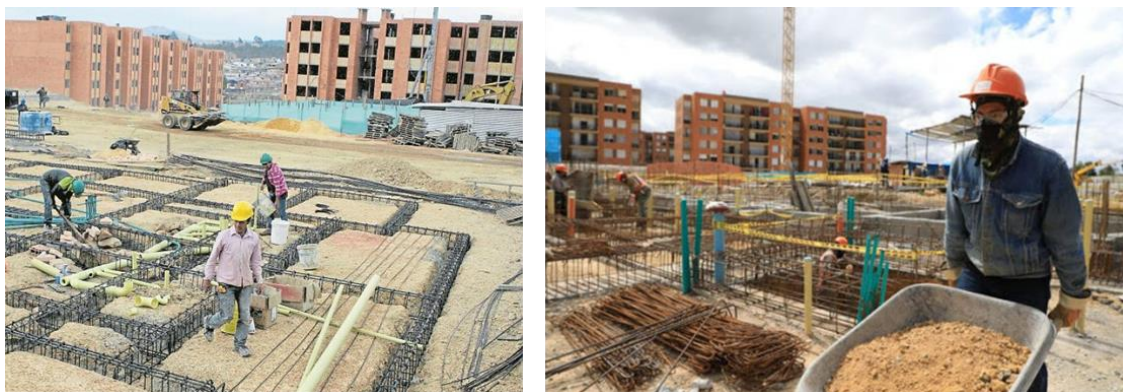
Construcción de losa de cimentación en viviendas VIS Fuente: <https://www.portafolio.co/mis-finanzas/vivienda/proyectos-nuevos-de-vivienda-con-menos-metros-en-construccion-520522> / <http://www.radiosantafe.com/2020/05/27/subsidios-para-construir-200-mil-viviendas-entregara-el-gobierno-nacional/>
